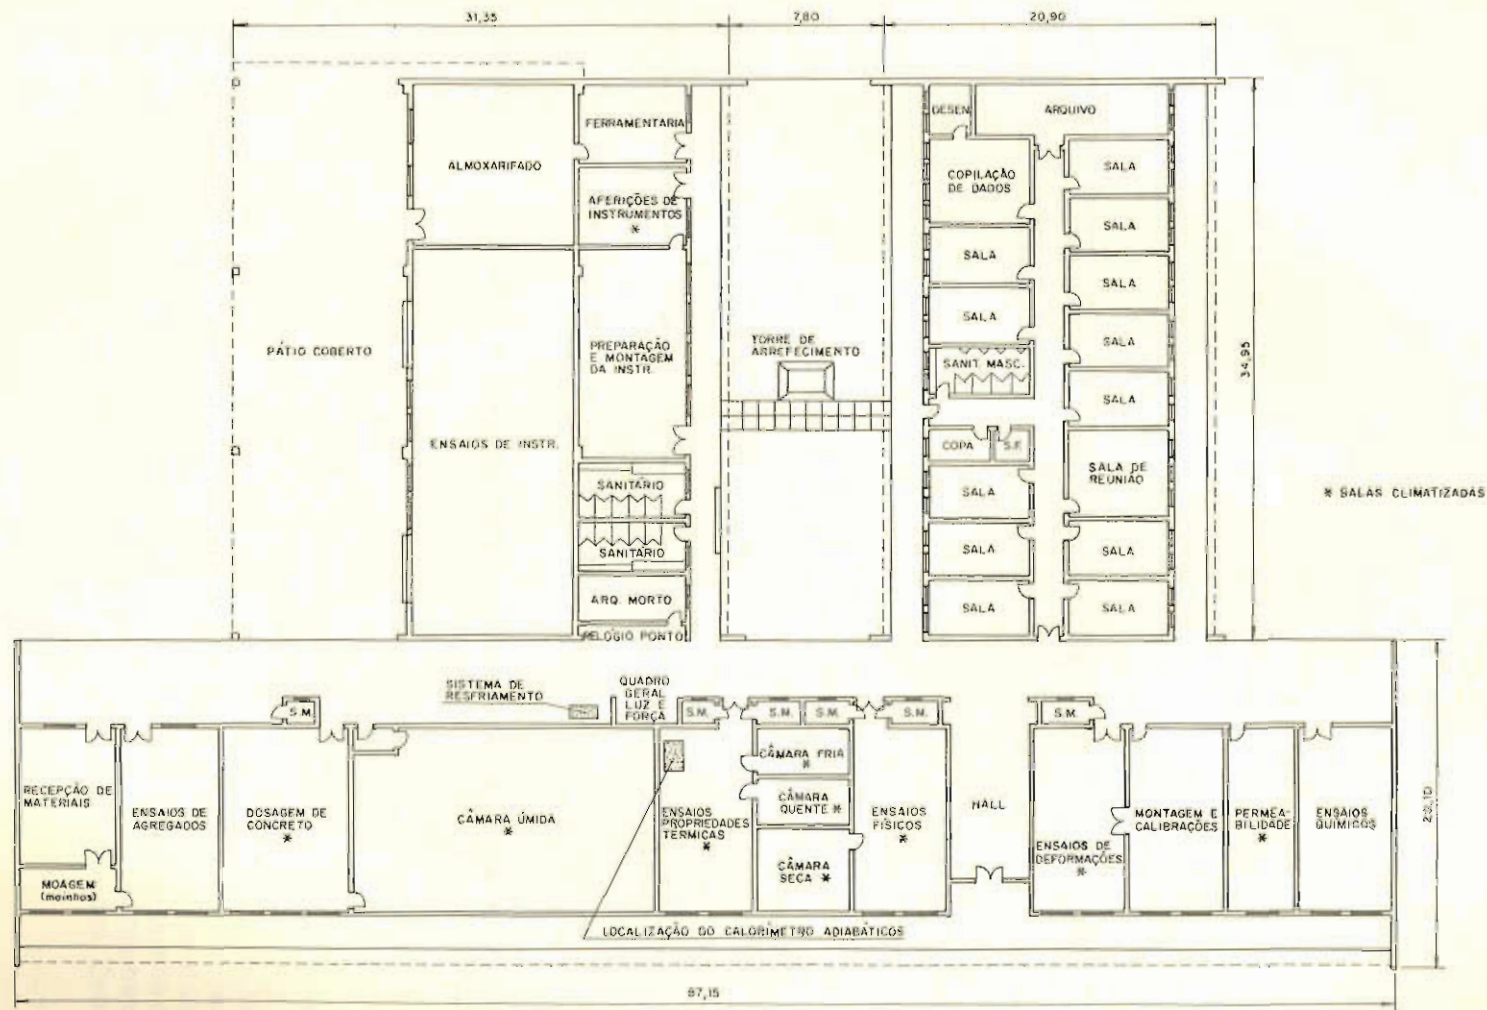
Planta do Laboratório de Concreto da Itaipu Binacional
